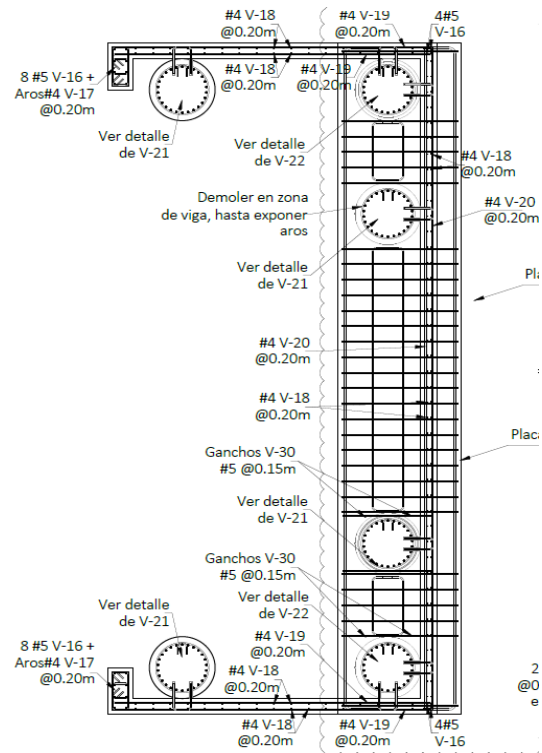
Acero de refuerzo viga y ménsula (Planta).
